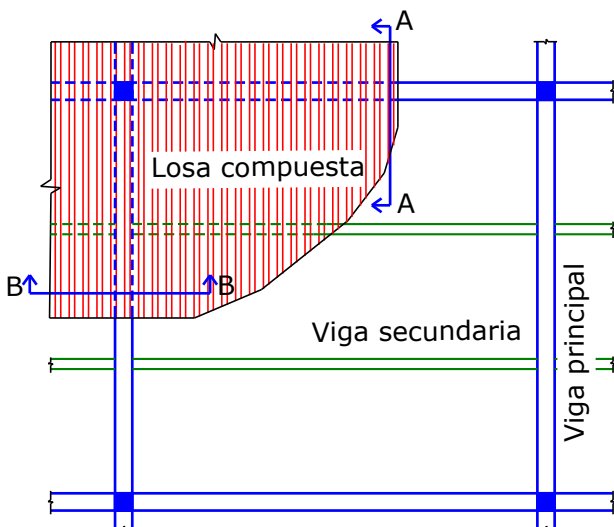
Losa compuesta con chapa colaborante que apoya sobre vigas de acero.
